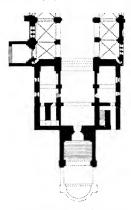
Grundrifs vor der Restauration von 1810—50. Erdgeschofs. (Nach Stüler und Lohde.)
